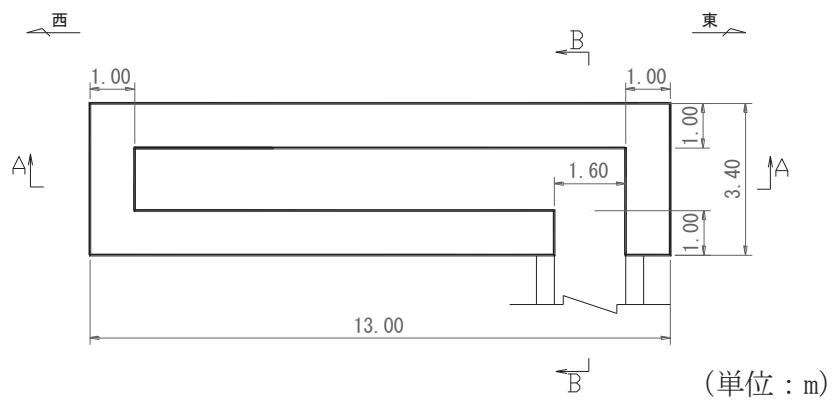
第 3 号機補機冷却海水系放水ピット平面図 (E-E 断面)
